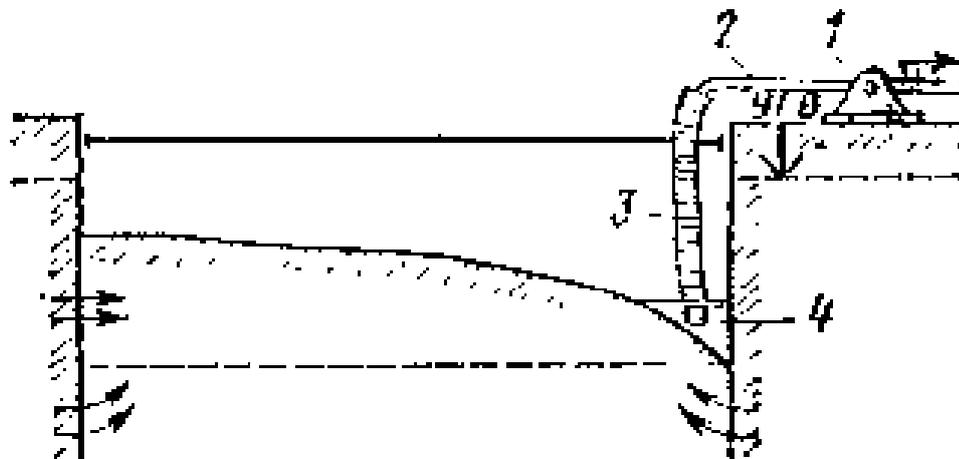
Схема удаления воды из котлована насосами: 1 – насос; 2 – нагнетательный шланг; 3 – всасывающий шланг; 4 – приямок
